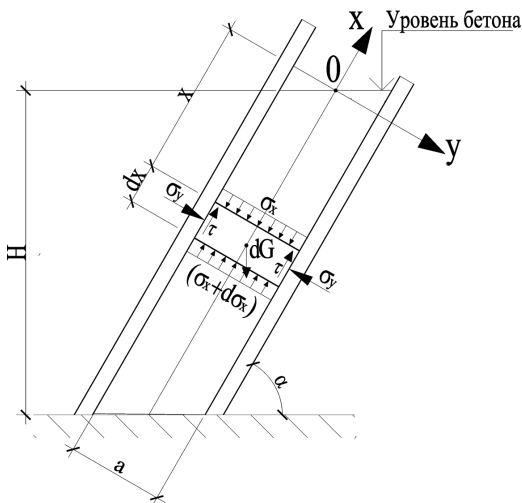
Расчетная схема определения давления бетонной смеси на наклонную опалубку
